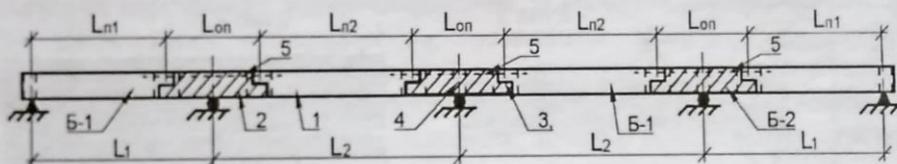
Схема розміщення збірних і монолітних головних балок в нерозрізній прогоновій будові моста: 1 - збірні в прогонах балки; 2 - монолітні або збірні балки над опорами; 3 - діафрагма у зоні стика; 4 - надопорна діафрагма; 5 - надопорна напружену арматура.
